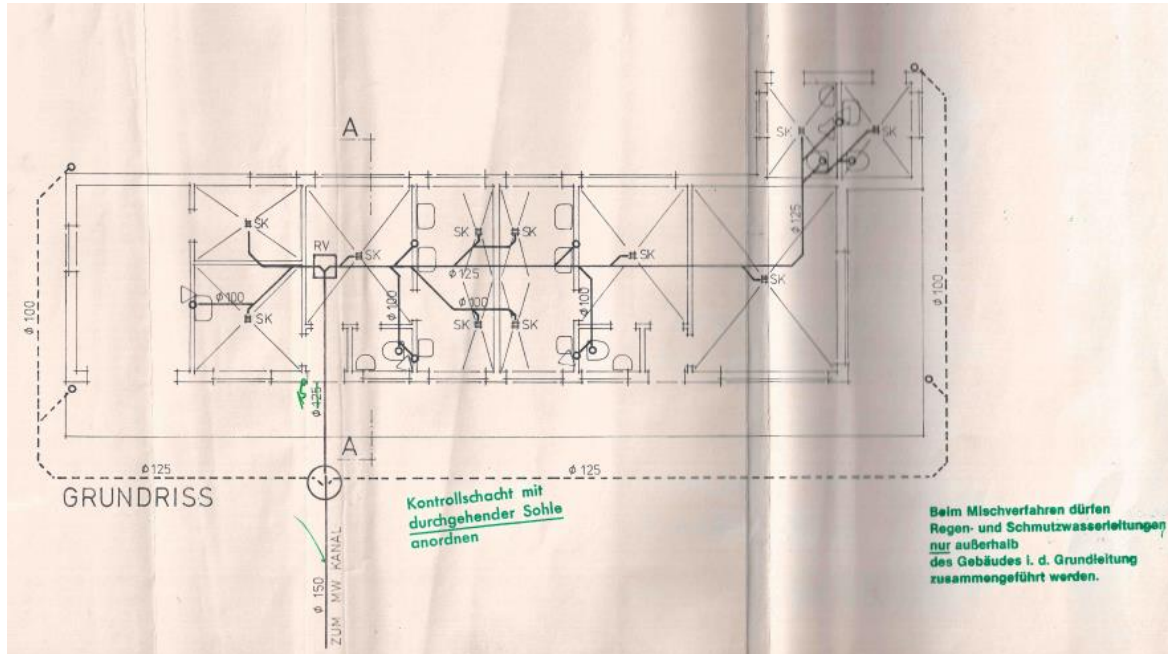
Grundriss des Umkleidegebäudes – Erdgeschoss Entwässerungsplan
